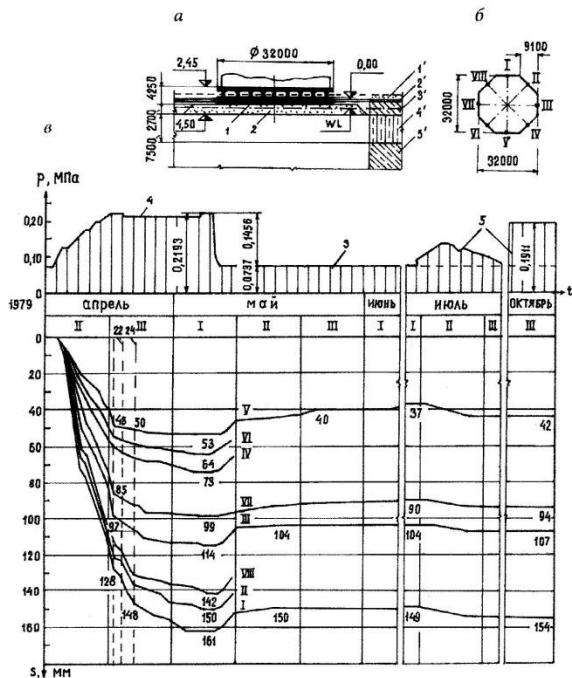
График осадок точек периметра фундамента изотермического хранилища жидкого аммиака на водонасыщенных глинистых грунтах в процессе испытаний: *а* – сечение фундамента и геологический разрез; *б* – план нижней фундаментной плиты; *в* – график $s = f(t)$ и $p = \varphi(t)$; 1 – фундамент; 2- шлаковая подушка, 3 – давление от постоянной нагрузки; 4 и 5 – то же от постоянной и временной нагрузок соответственно при испытании и эксплуатации; I-VIII – деформационные марки; 1' и 2' – насыпной грунт; 3' и 5' – суглинок лёссовый; 4' - лёсс
